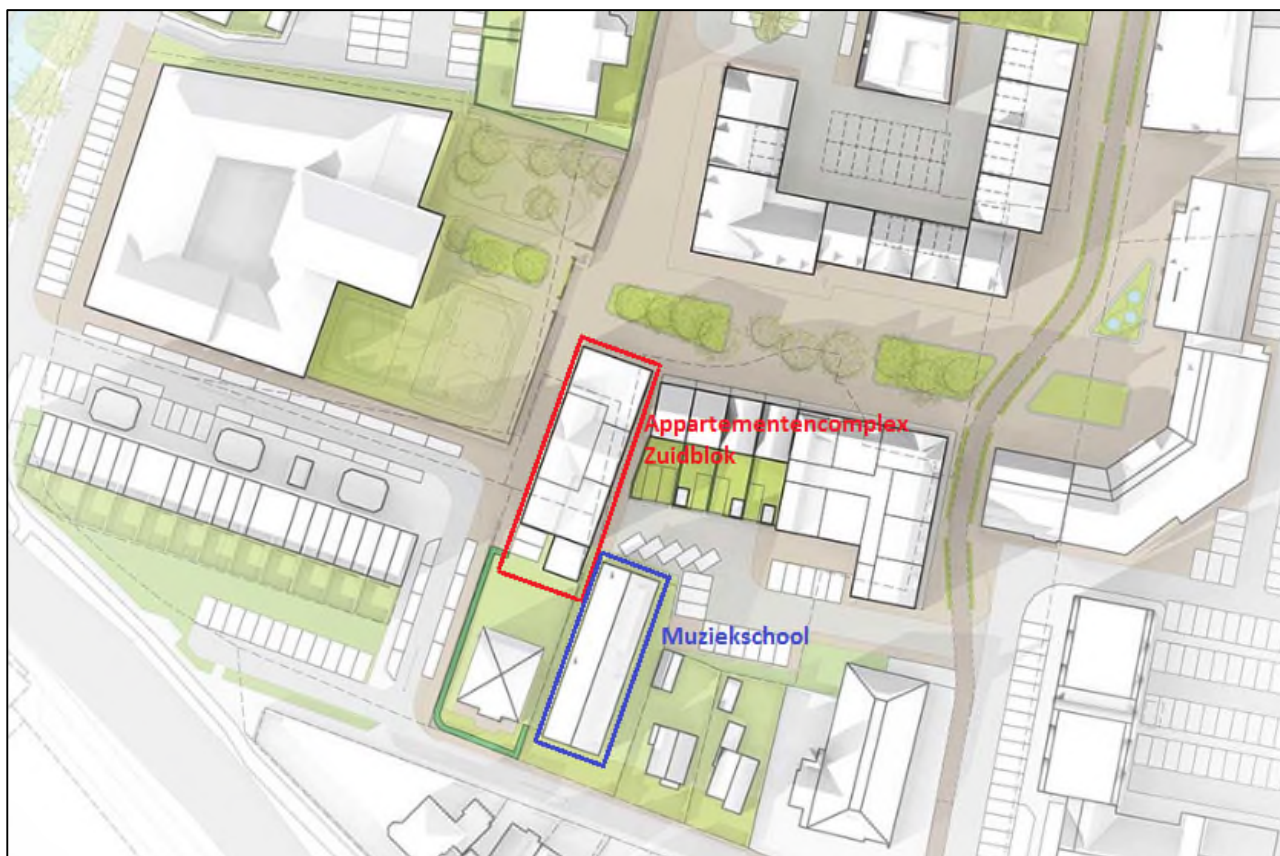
Impressie plan Harmonieplein (bron: Stedenbouwkundig plan Harmonieplein – Gemeente Stichtse Vecht)
